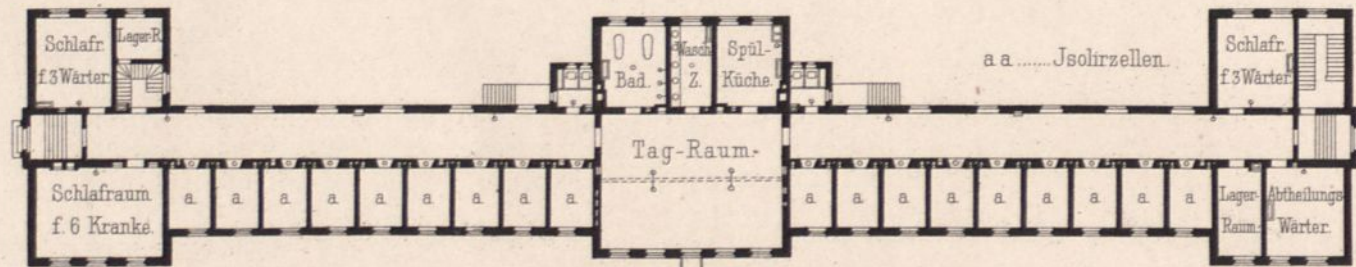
Krankenhaus D. Grundriß des Hauptgeschosses.
